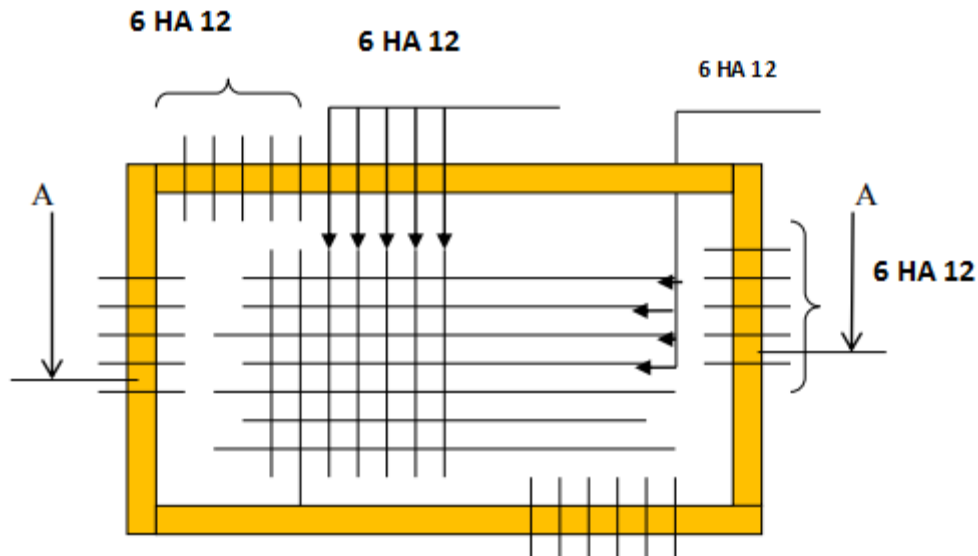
Schéma de ferrailage de la dalle de radier.
